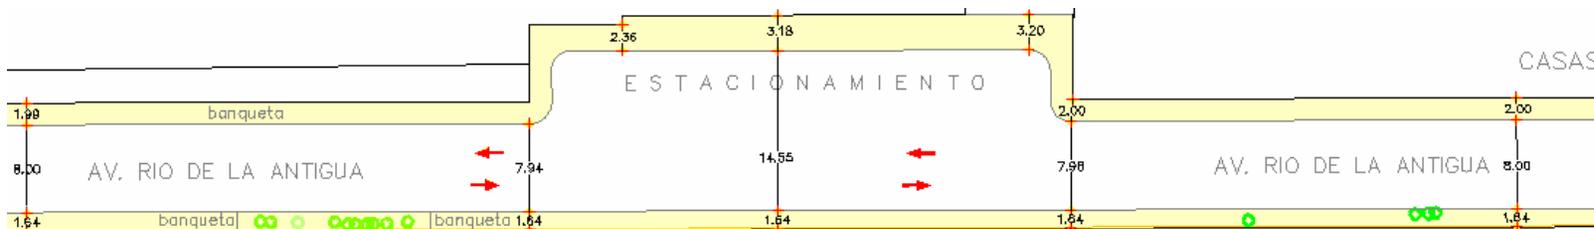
Banqueta del terreno 1.64m con algunos árboles como pinos. El arroyo vehicular aumenta en esta sección por un estacionamiento que se encuentra frente al terreno a 14.55m.
